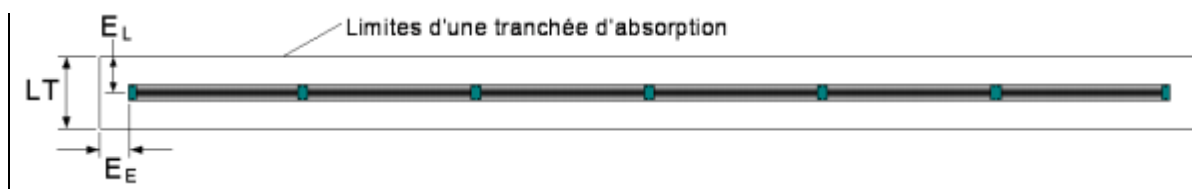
Vue en plan illustrant les critères d'espacement horizontal de la tranchée d'infiltration d'un System O))
